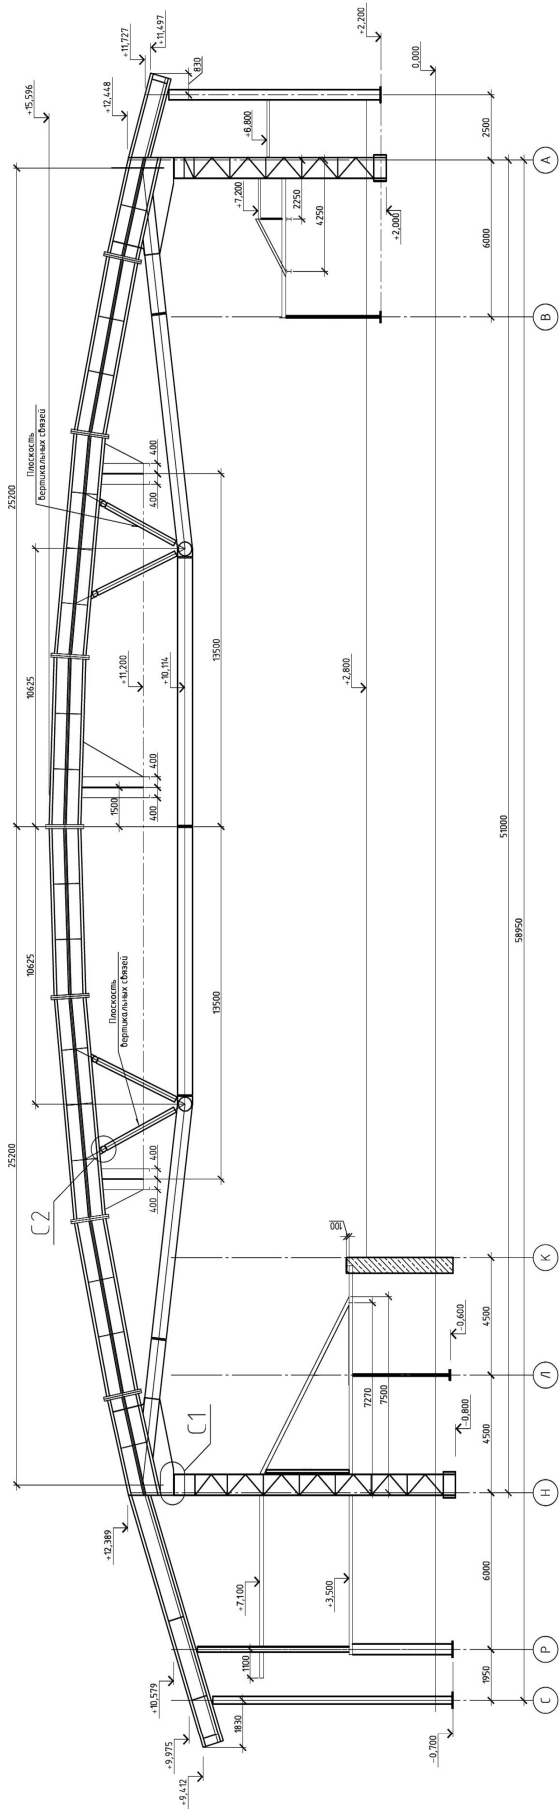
Поперечный разрез каркаса здания, опорный узел (С1) и узел сопряжения V-стойки с нижней полкой арки (С2)
